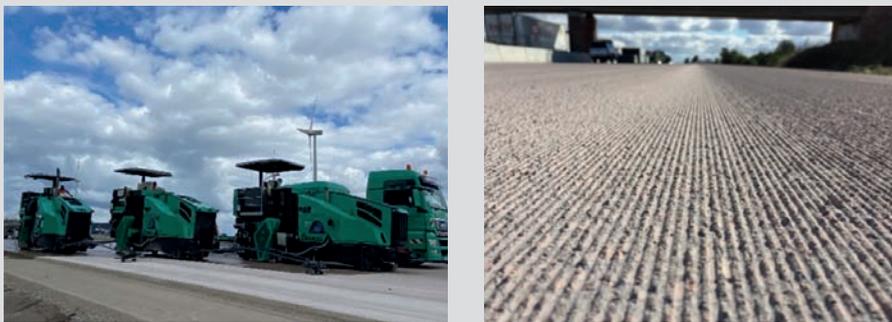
(links) Grindingmaschinen, (rechts) Grindingtextur
